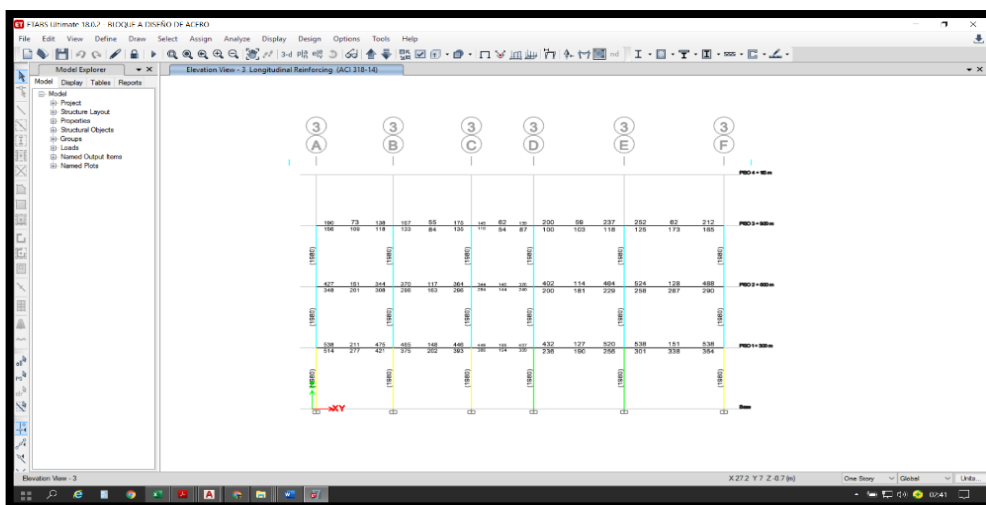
Bloque A - Acero longitudinal en el eje elevación eje 3-3
